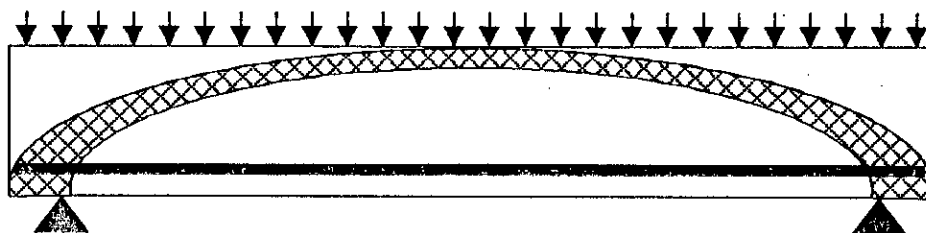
comportement structural d'une poutre sans armatures d'âme après fissuration
